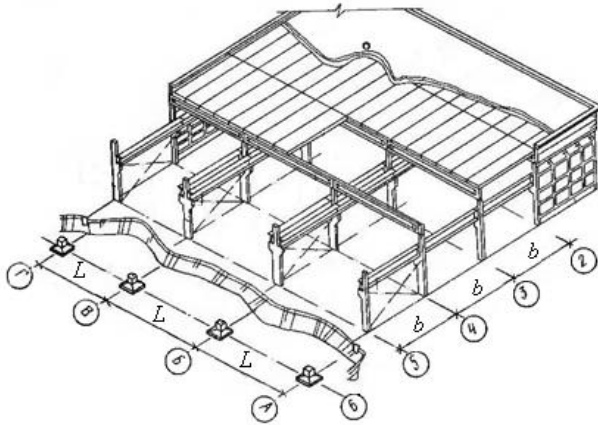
Одноповерхова будівля із залізобетонним каркасом:
